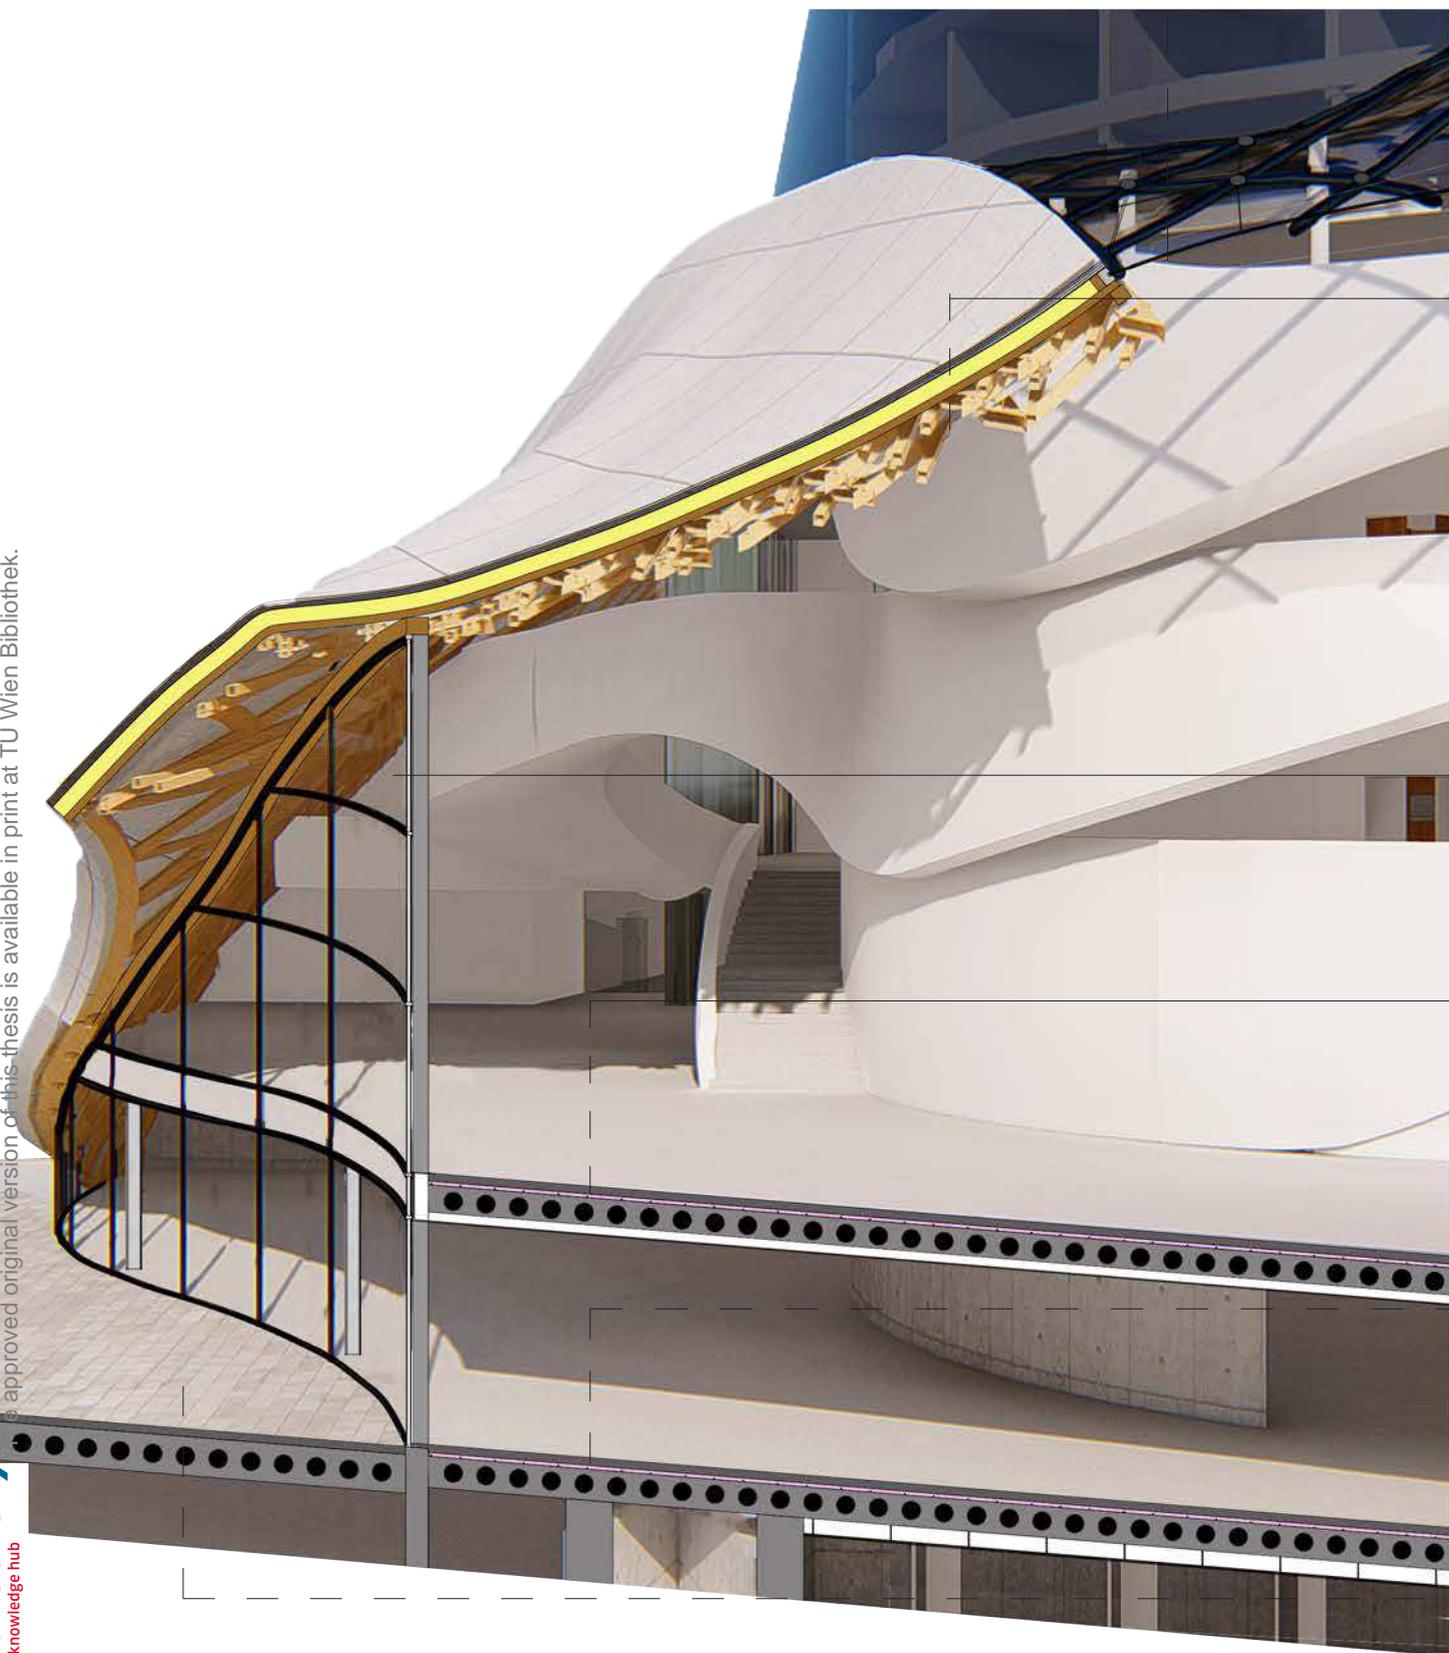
Fassadenschnitt - Dach über Eingangs-Foyer M1:100
